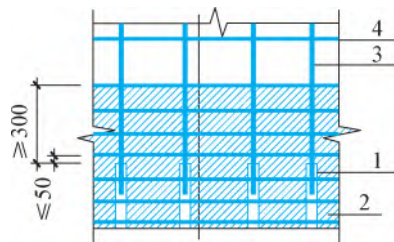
钢筋套筒灌浆连接部位分布钢筋的加密构造示意
